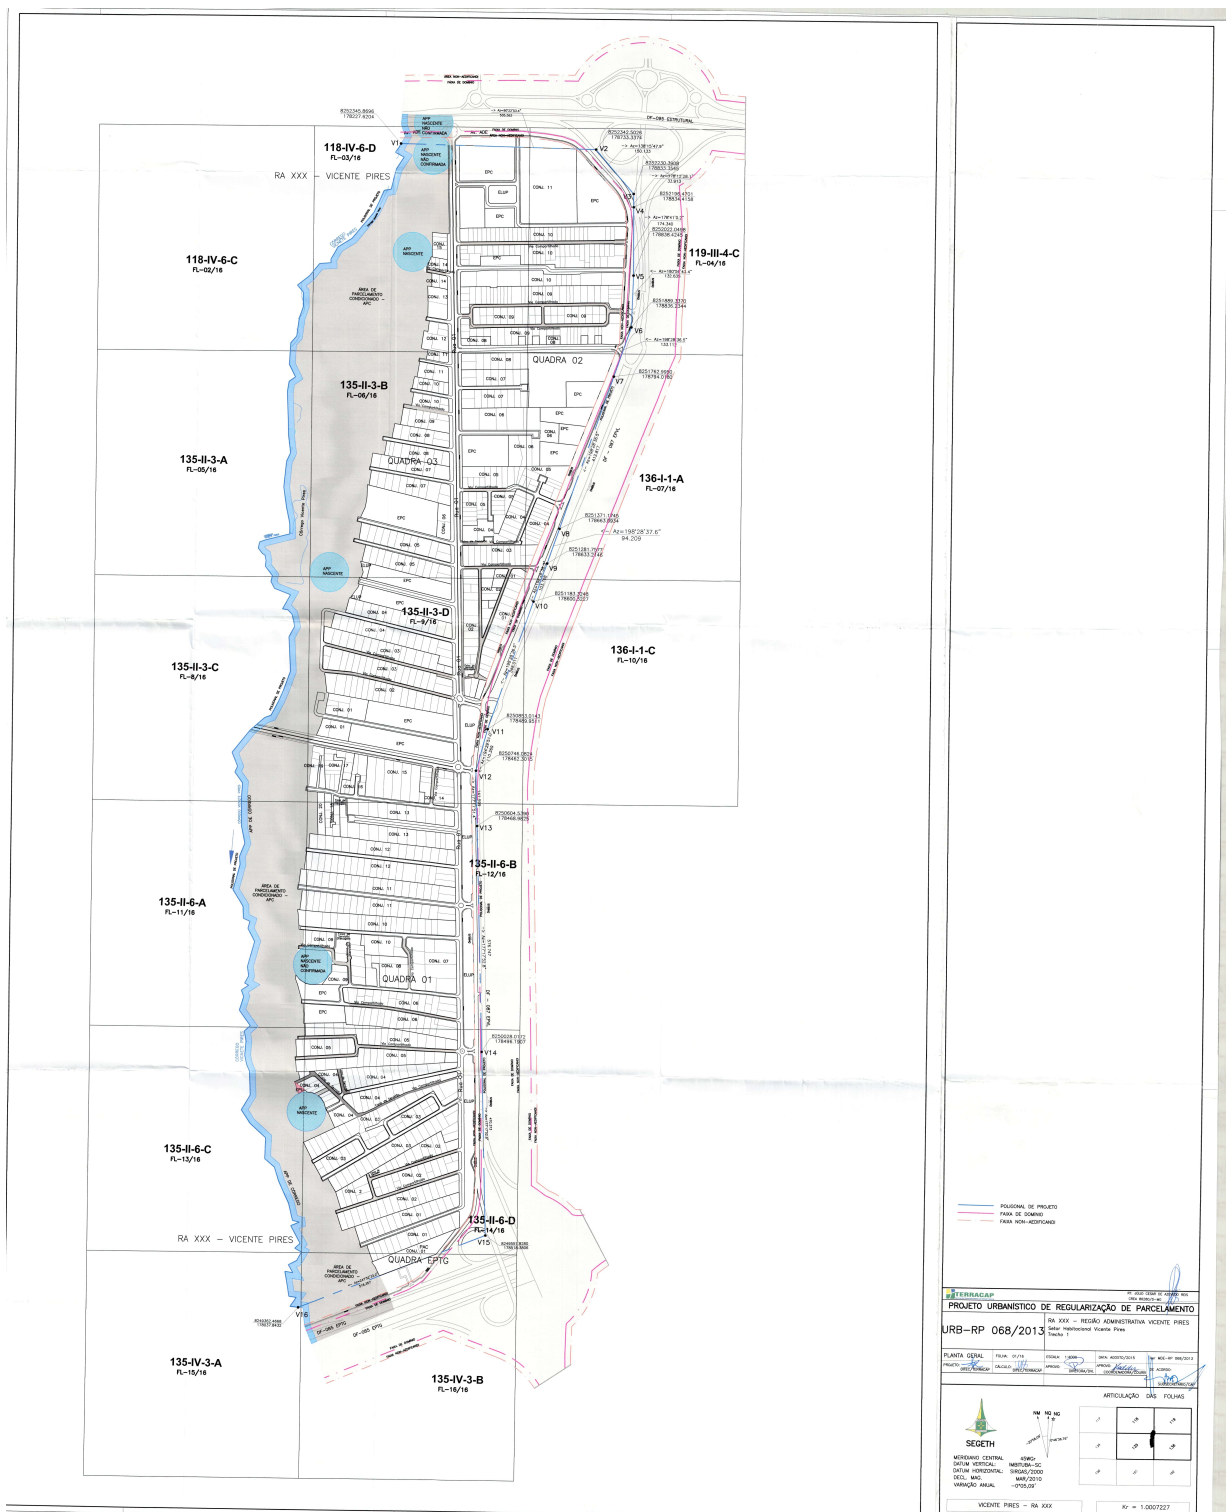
Planta Geral do Projeto de Urbanismo - URB - RP 068/2013
